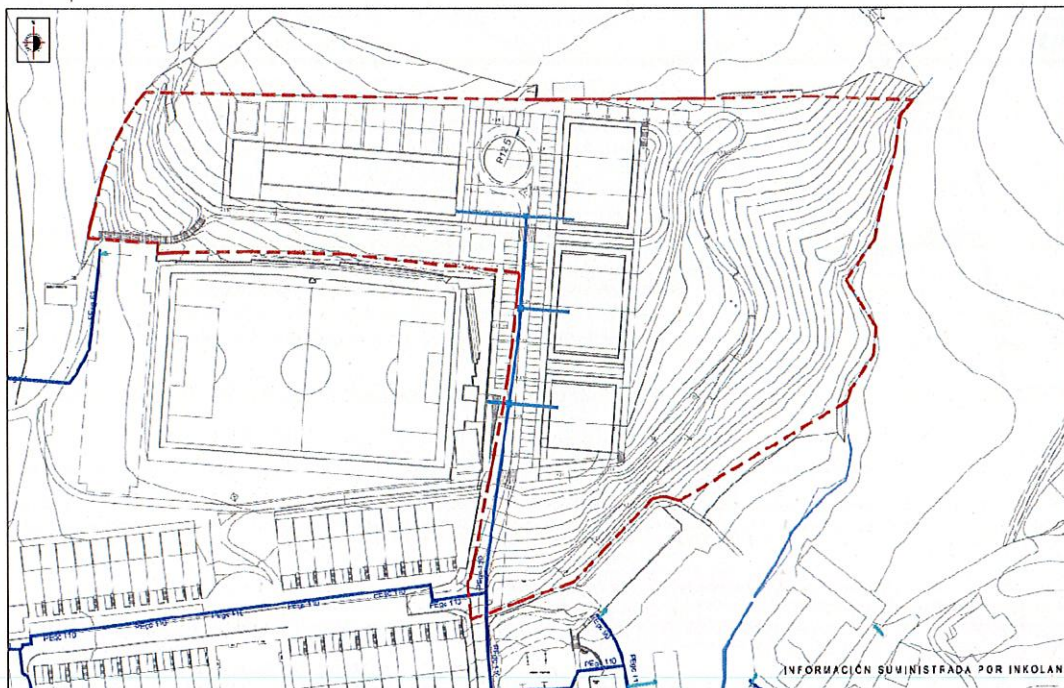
IMAGEN DEL ESTADO REFORMADO DE LA RED DE SUMINISTRO DE GAS VER PLANO B.2.2.4
